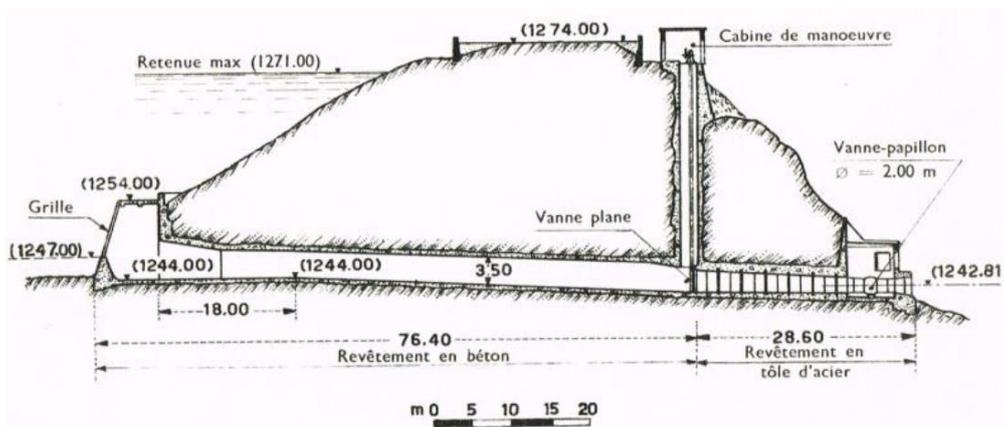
Diga di Trepidò, scarico di alleggerimento (Progetto storico, quote FCEM)
